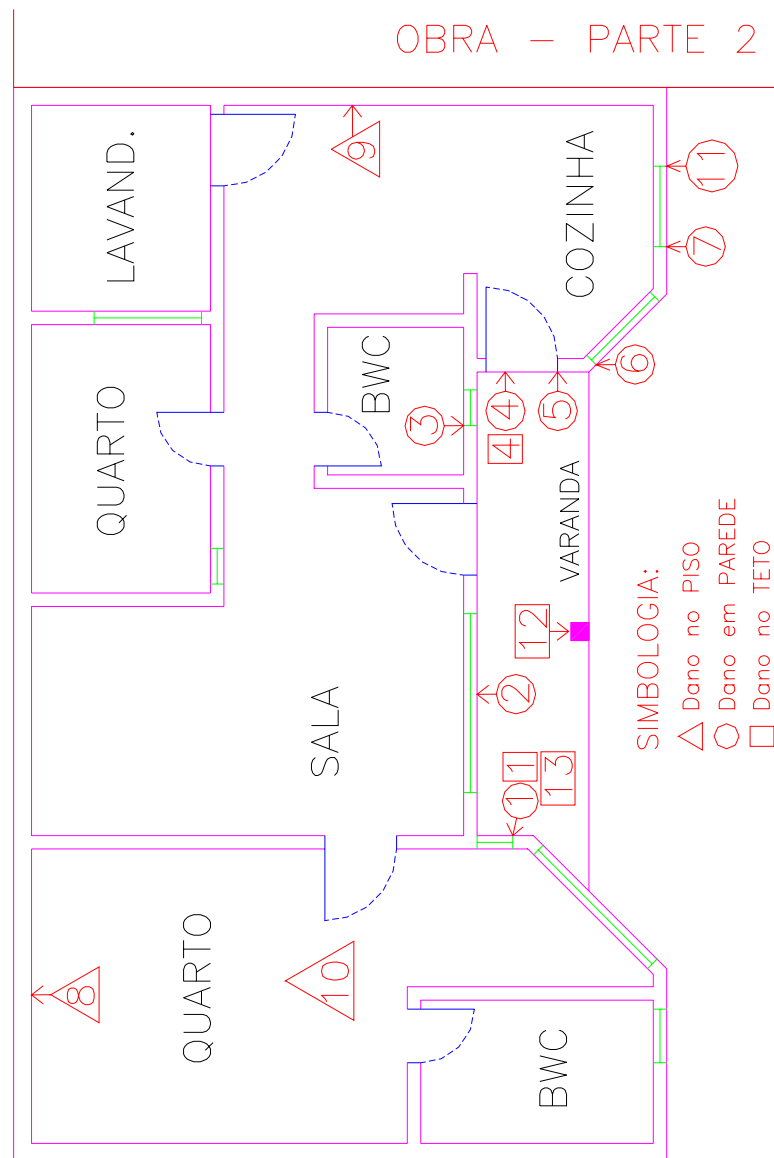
Planta da casa, com indicações das posições das avarias (danos) constatadas (rachaduras em pisos, paredes, viga e laje de teto)
